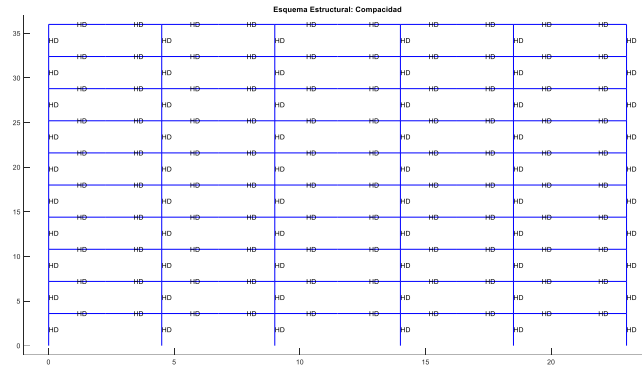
Compacidad de secciones del pórtico, estructura SMF, Ejes 1, 3.
